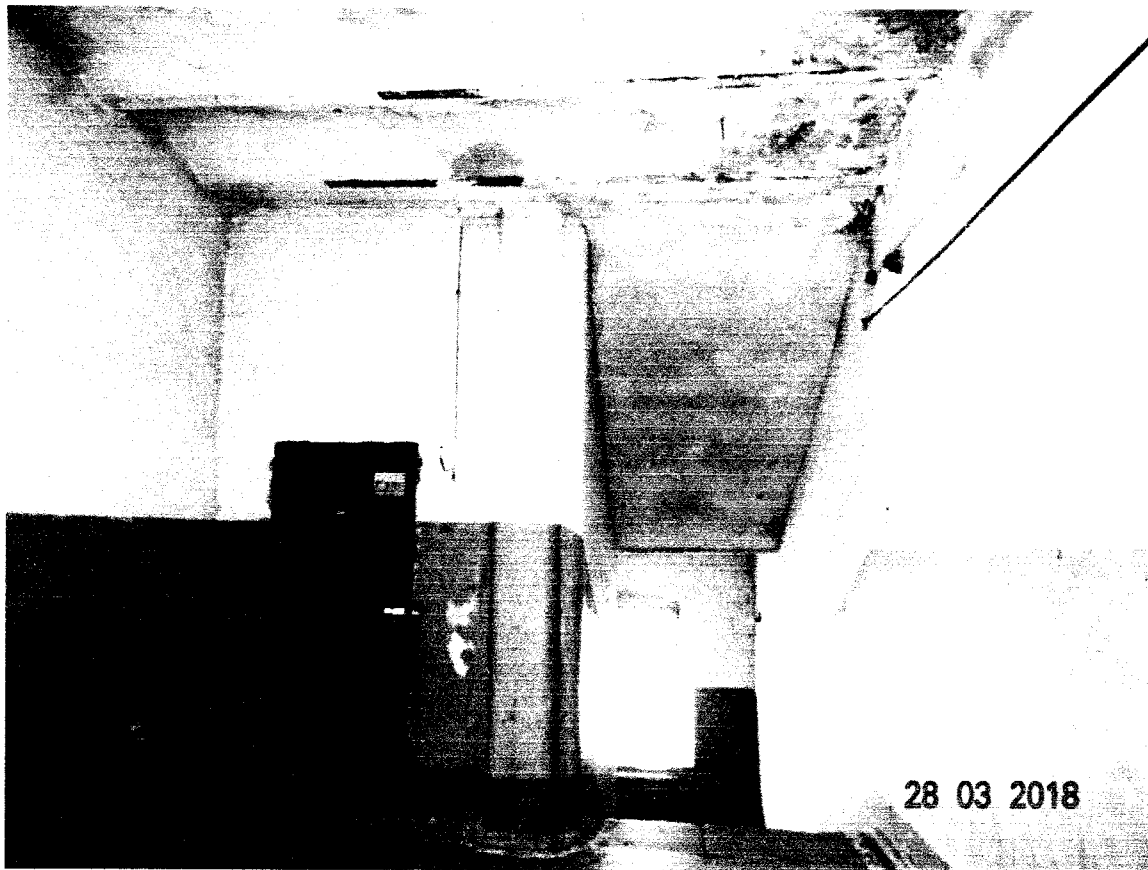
Лестница левого ризалита. Площадка третьего этажа
